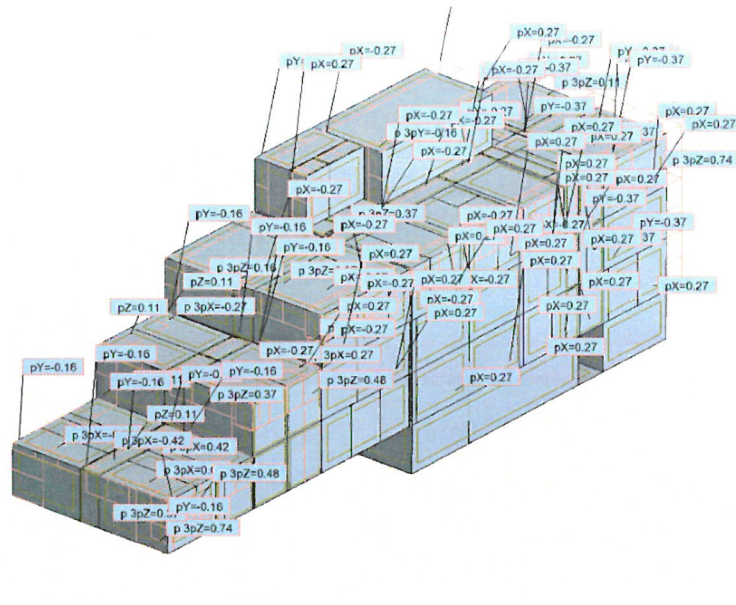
Przypadek obciążenia od wiatru 1 na konstrukcję
